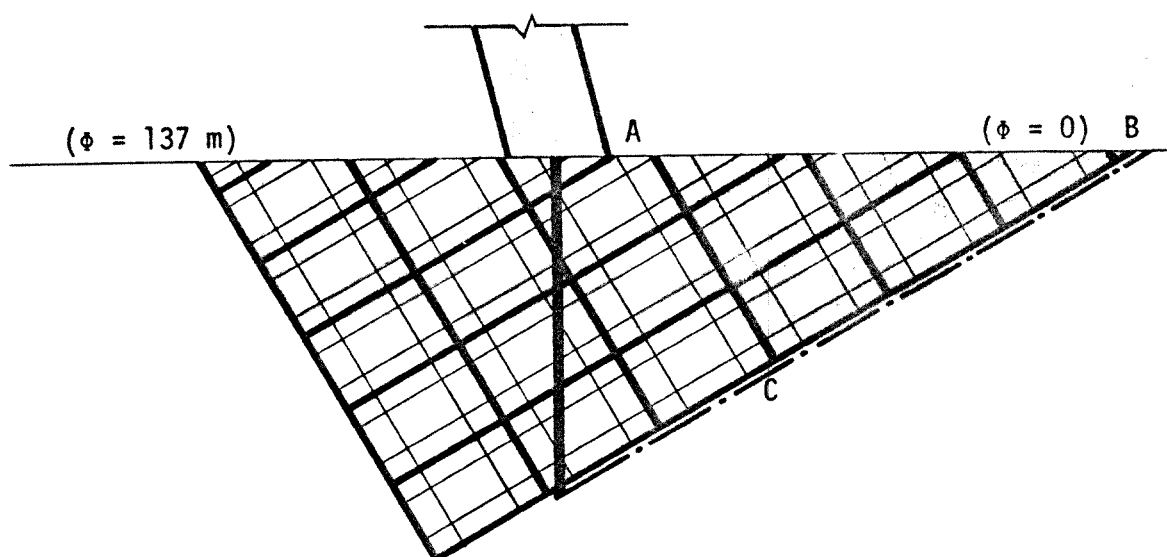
Zona de jusante da fundação de uma barragem em cúpula.
